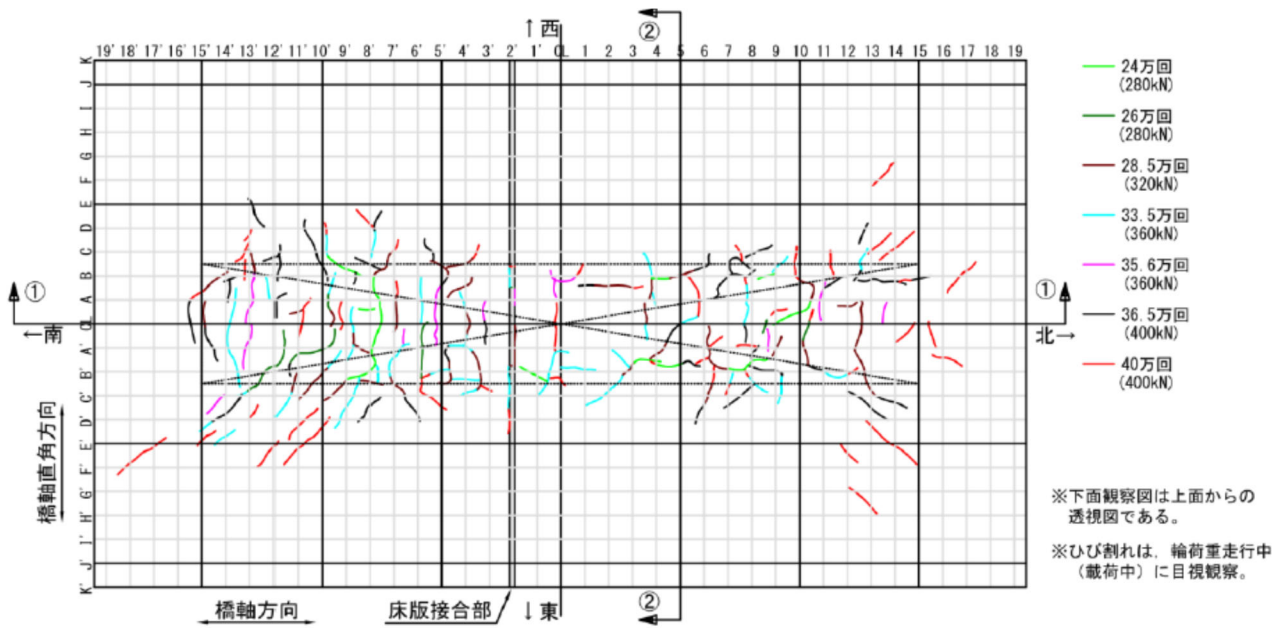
ひび割れ図 (床版下面)
